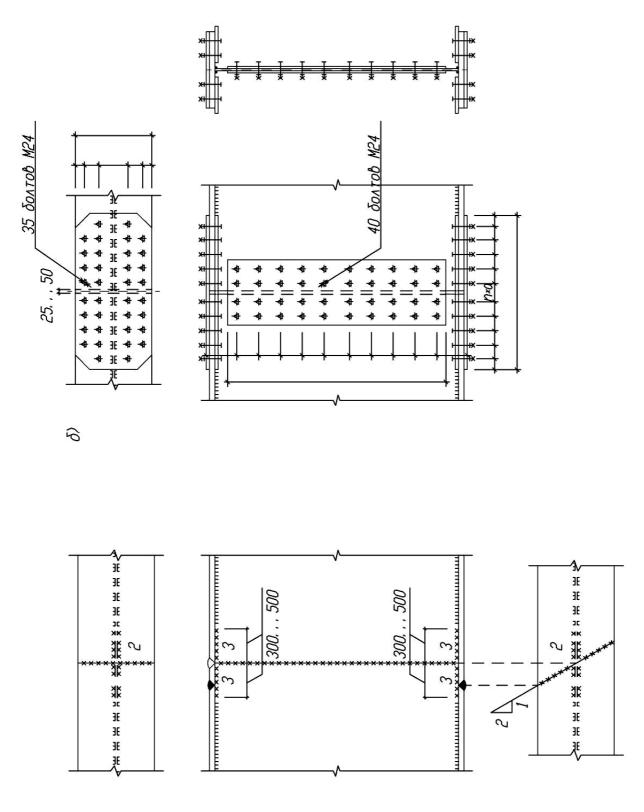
Укрупнительные швы главных балок: a — сварной; δ — на высокопрочных болтах
